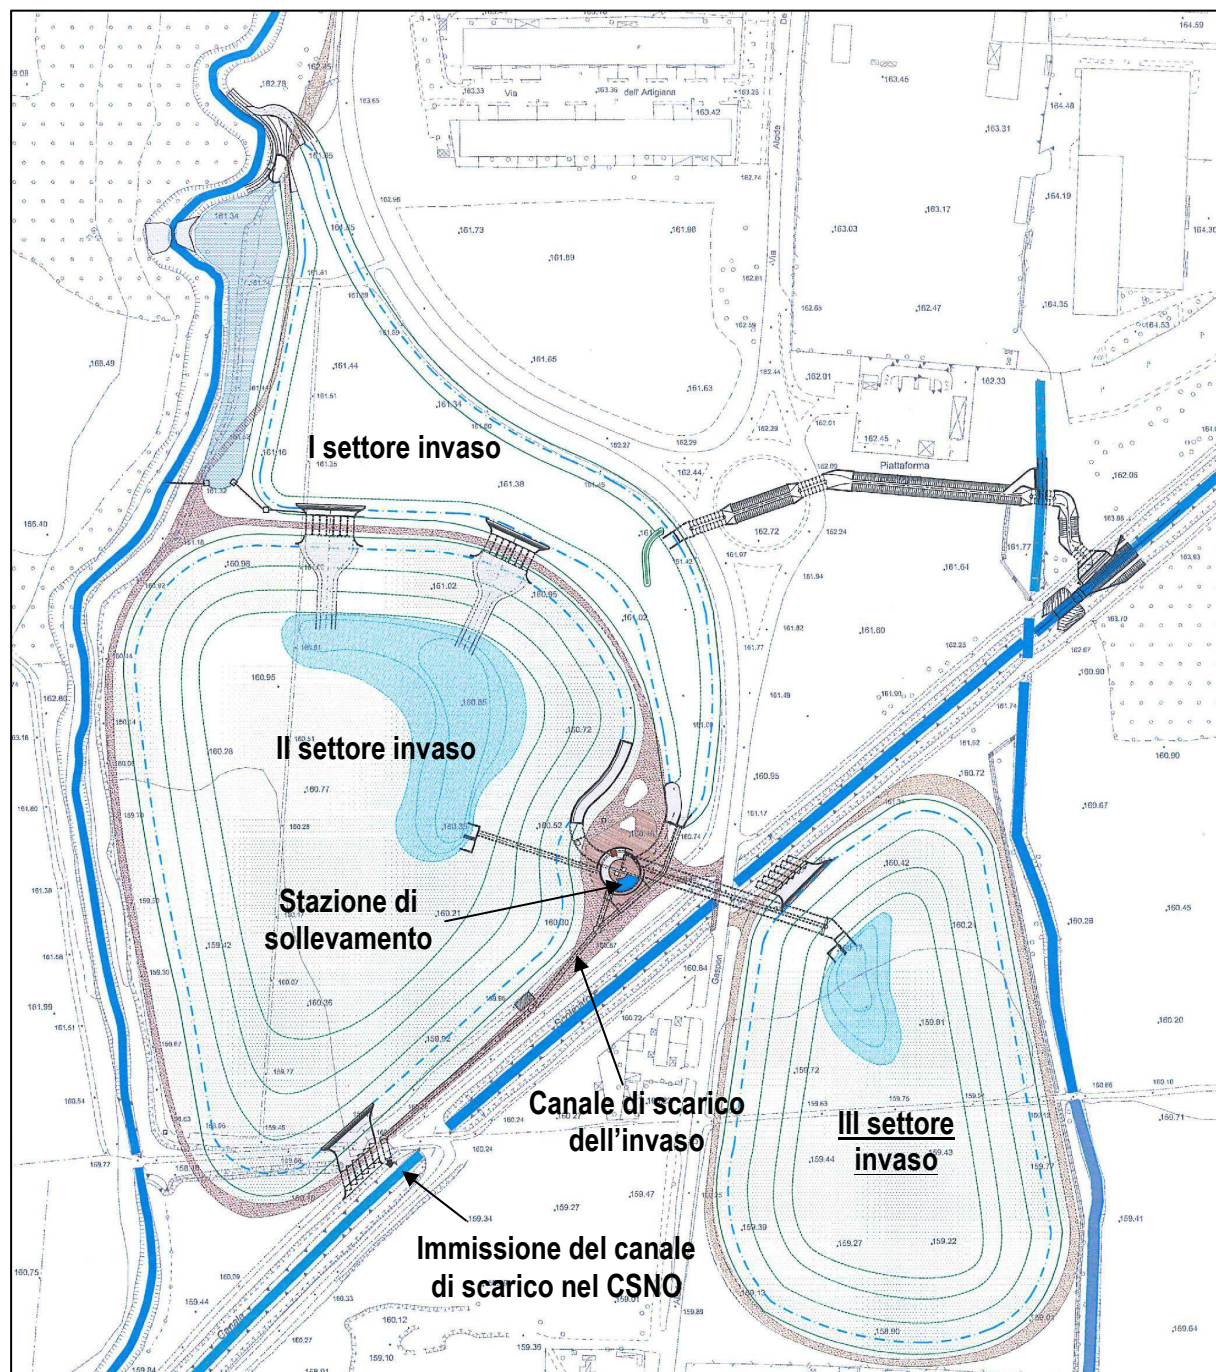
Planimetria della vasca di laminazione di Senago con indicazione delle opere idrauliche di scarico
